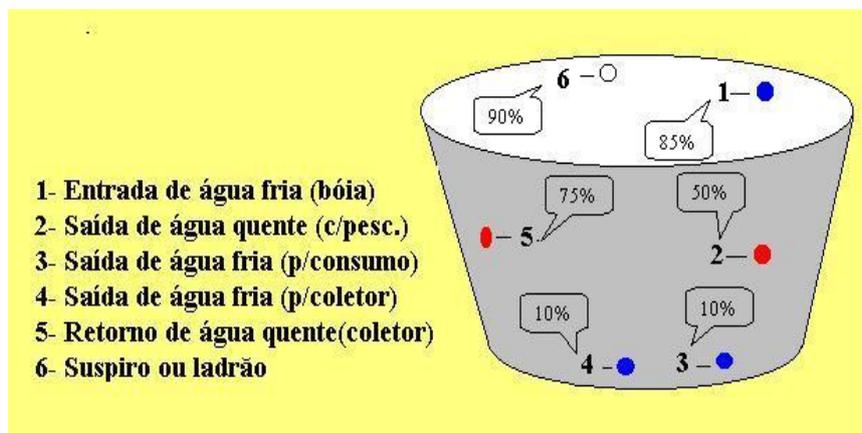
Fonte: manual sobre a construção instalação do aquecedor solar 2006.
